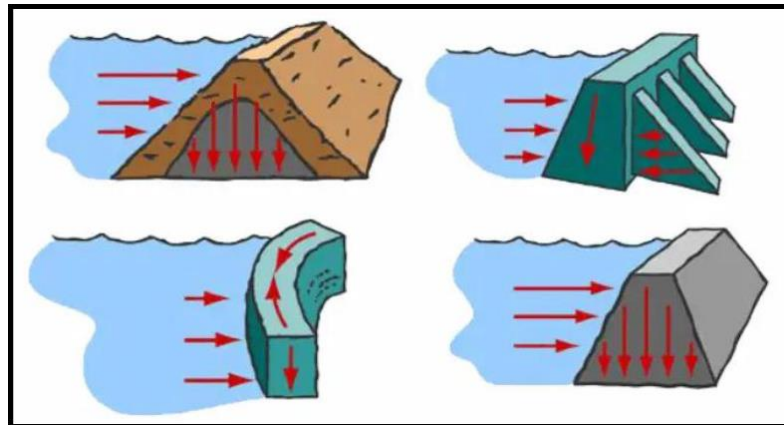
coupe d'un barrage poids (Sadiq, 2022)
